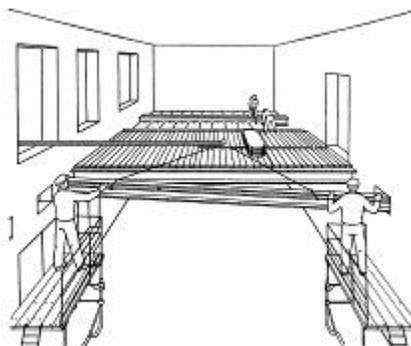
Общая схема организации работ по монтажу участка перекрытия из железобетонных швеллерных балок с помощью строительного подъемника СП-06
